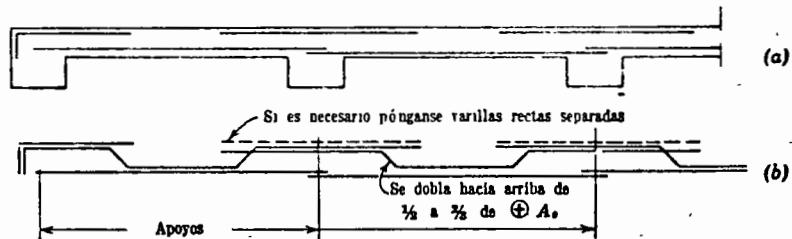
Colocación del acero en la losa. (a) Usando solamente varillas rectas. (b) Doblando algunas varillas
